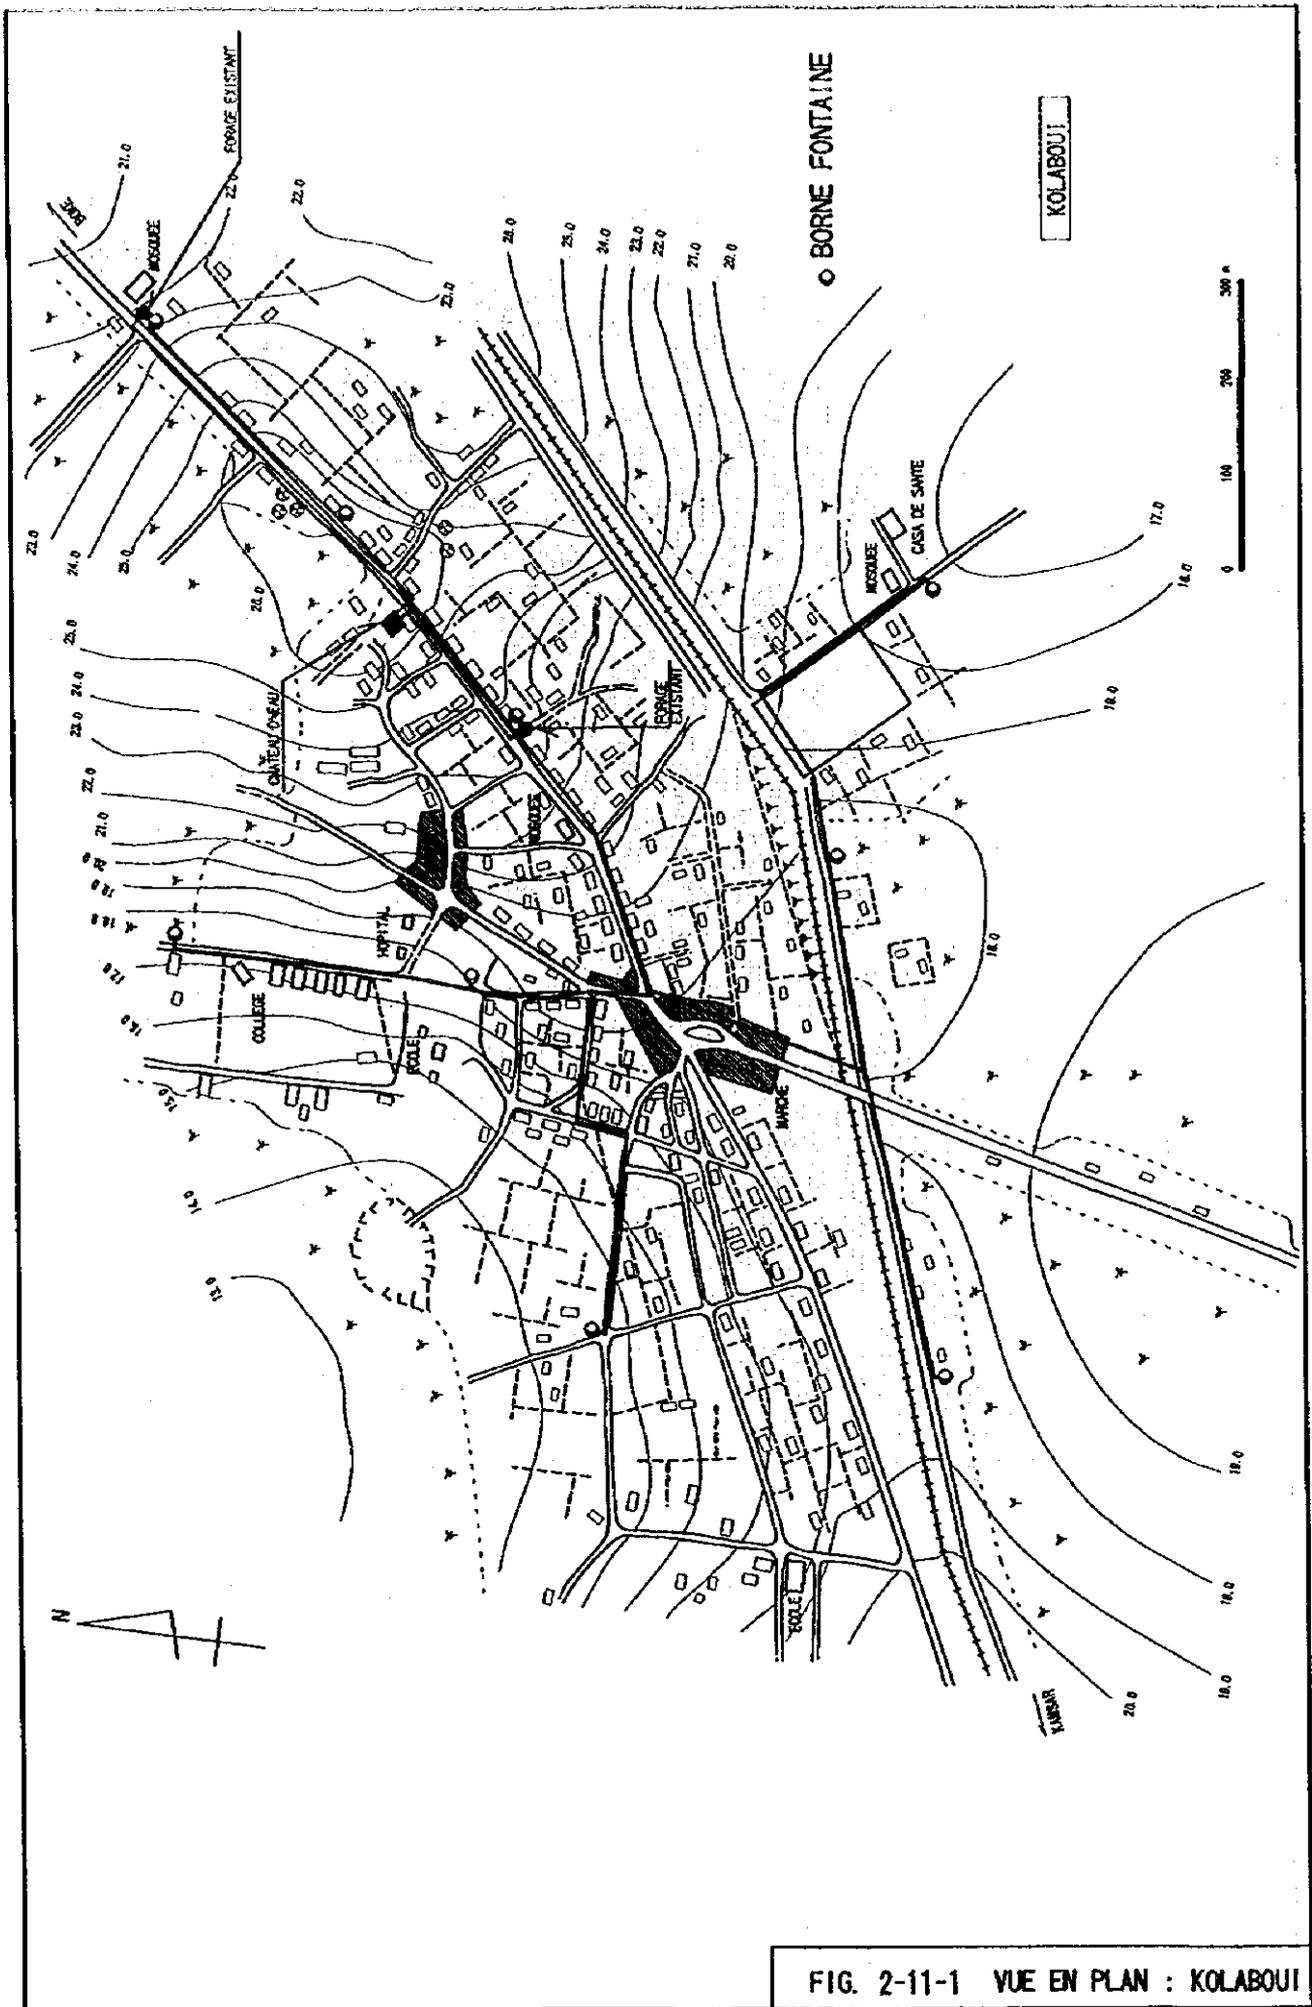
VUE EN PLAN : KOLABOUJ
